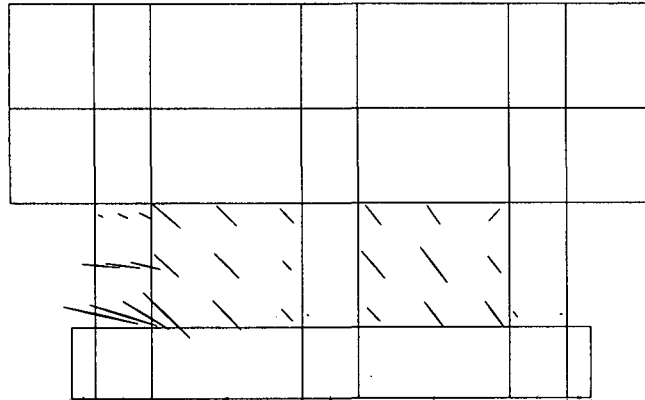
可動支承橋脚のひび割れ状況
